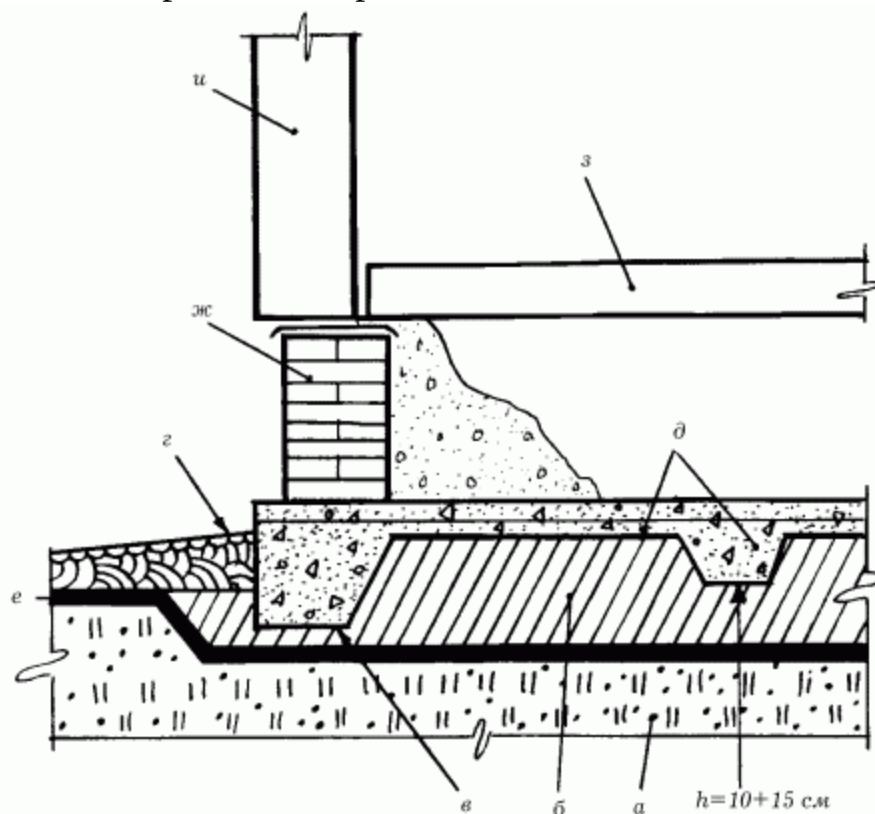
Устройство плавающего фундамента: а – пучинистый грунт основания; б – уплотненный насыпной грунт; в – ребро; г –
